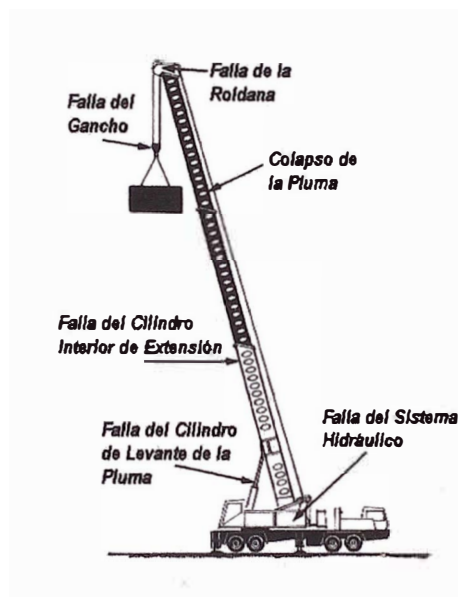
FALLAS ESTRUCTURALES EN UNA GRÚA
